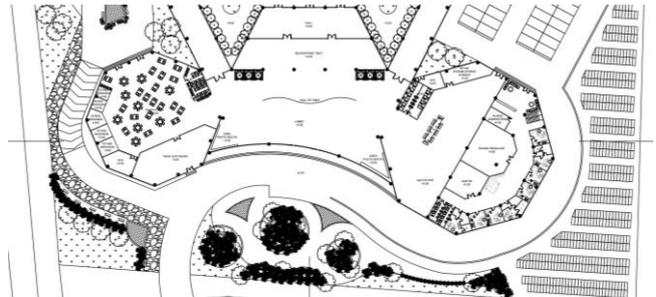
Denah lantai 3. Sumber: penulis
